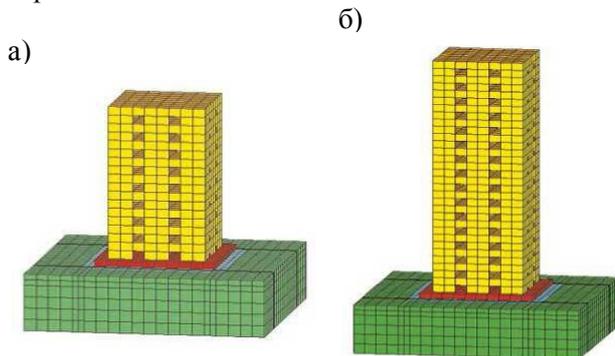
Расчетная модел: а — 9-этажное здание; б — 16-этажное здание.
